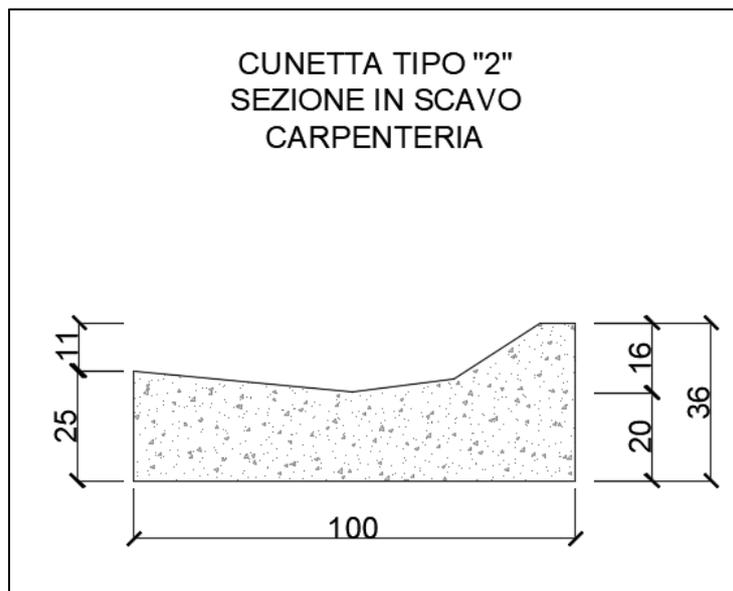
Sistema di scarico in rilevato – cunetta tipo "2"
